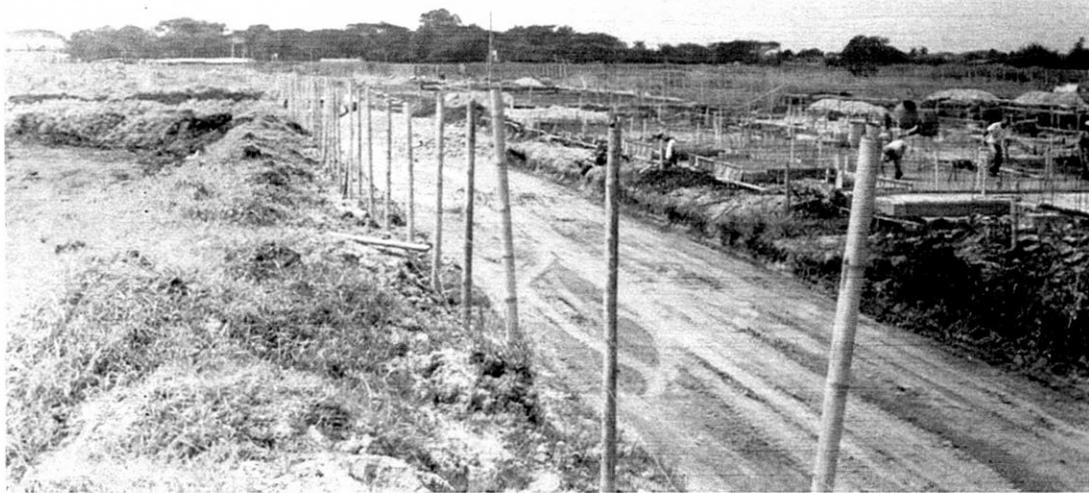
Paisaje intervenido por las constructoras Moreno Tafurt y Las Palmas
